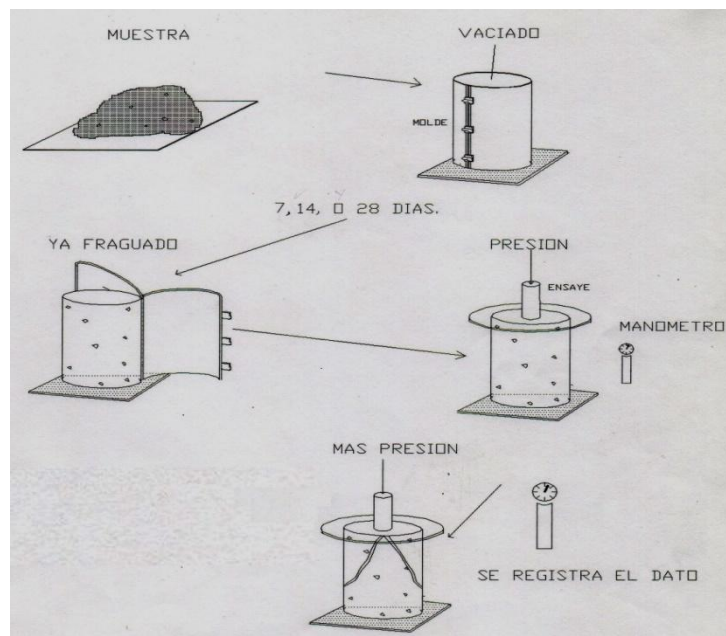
Croquis simplificado del muestreo y ensaye para cilindros de concreto.
